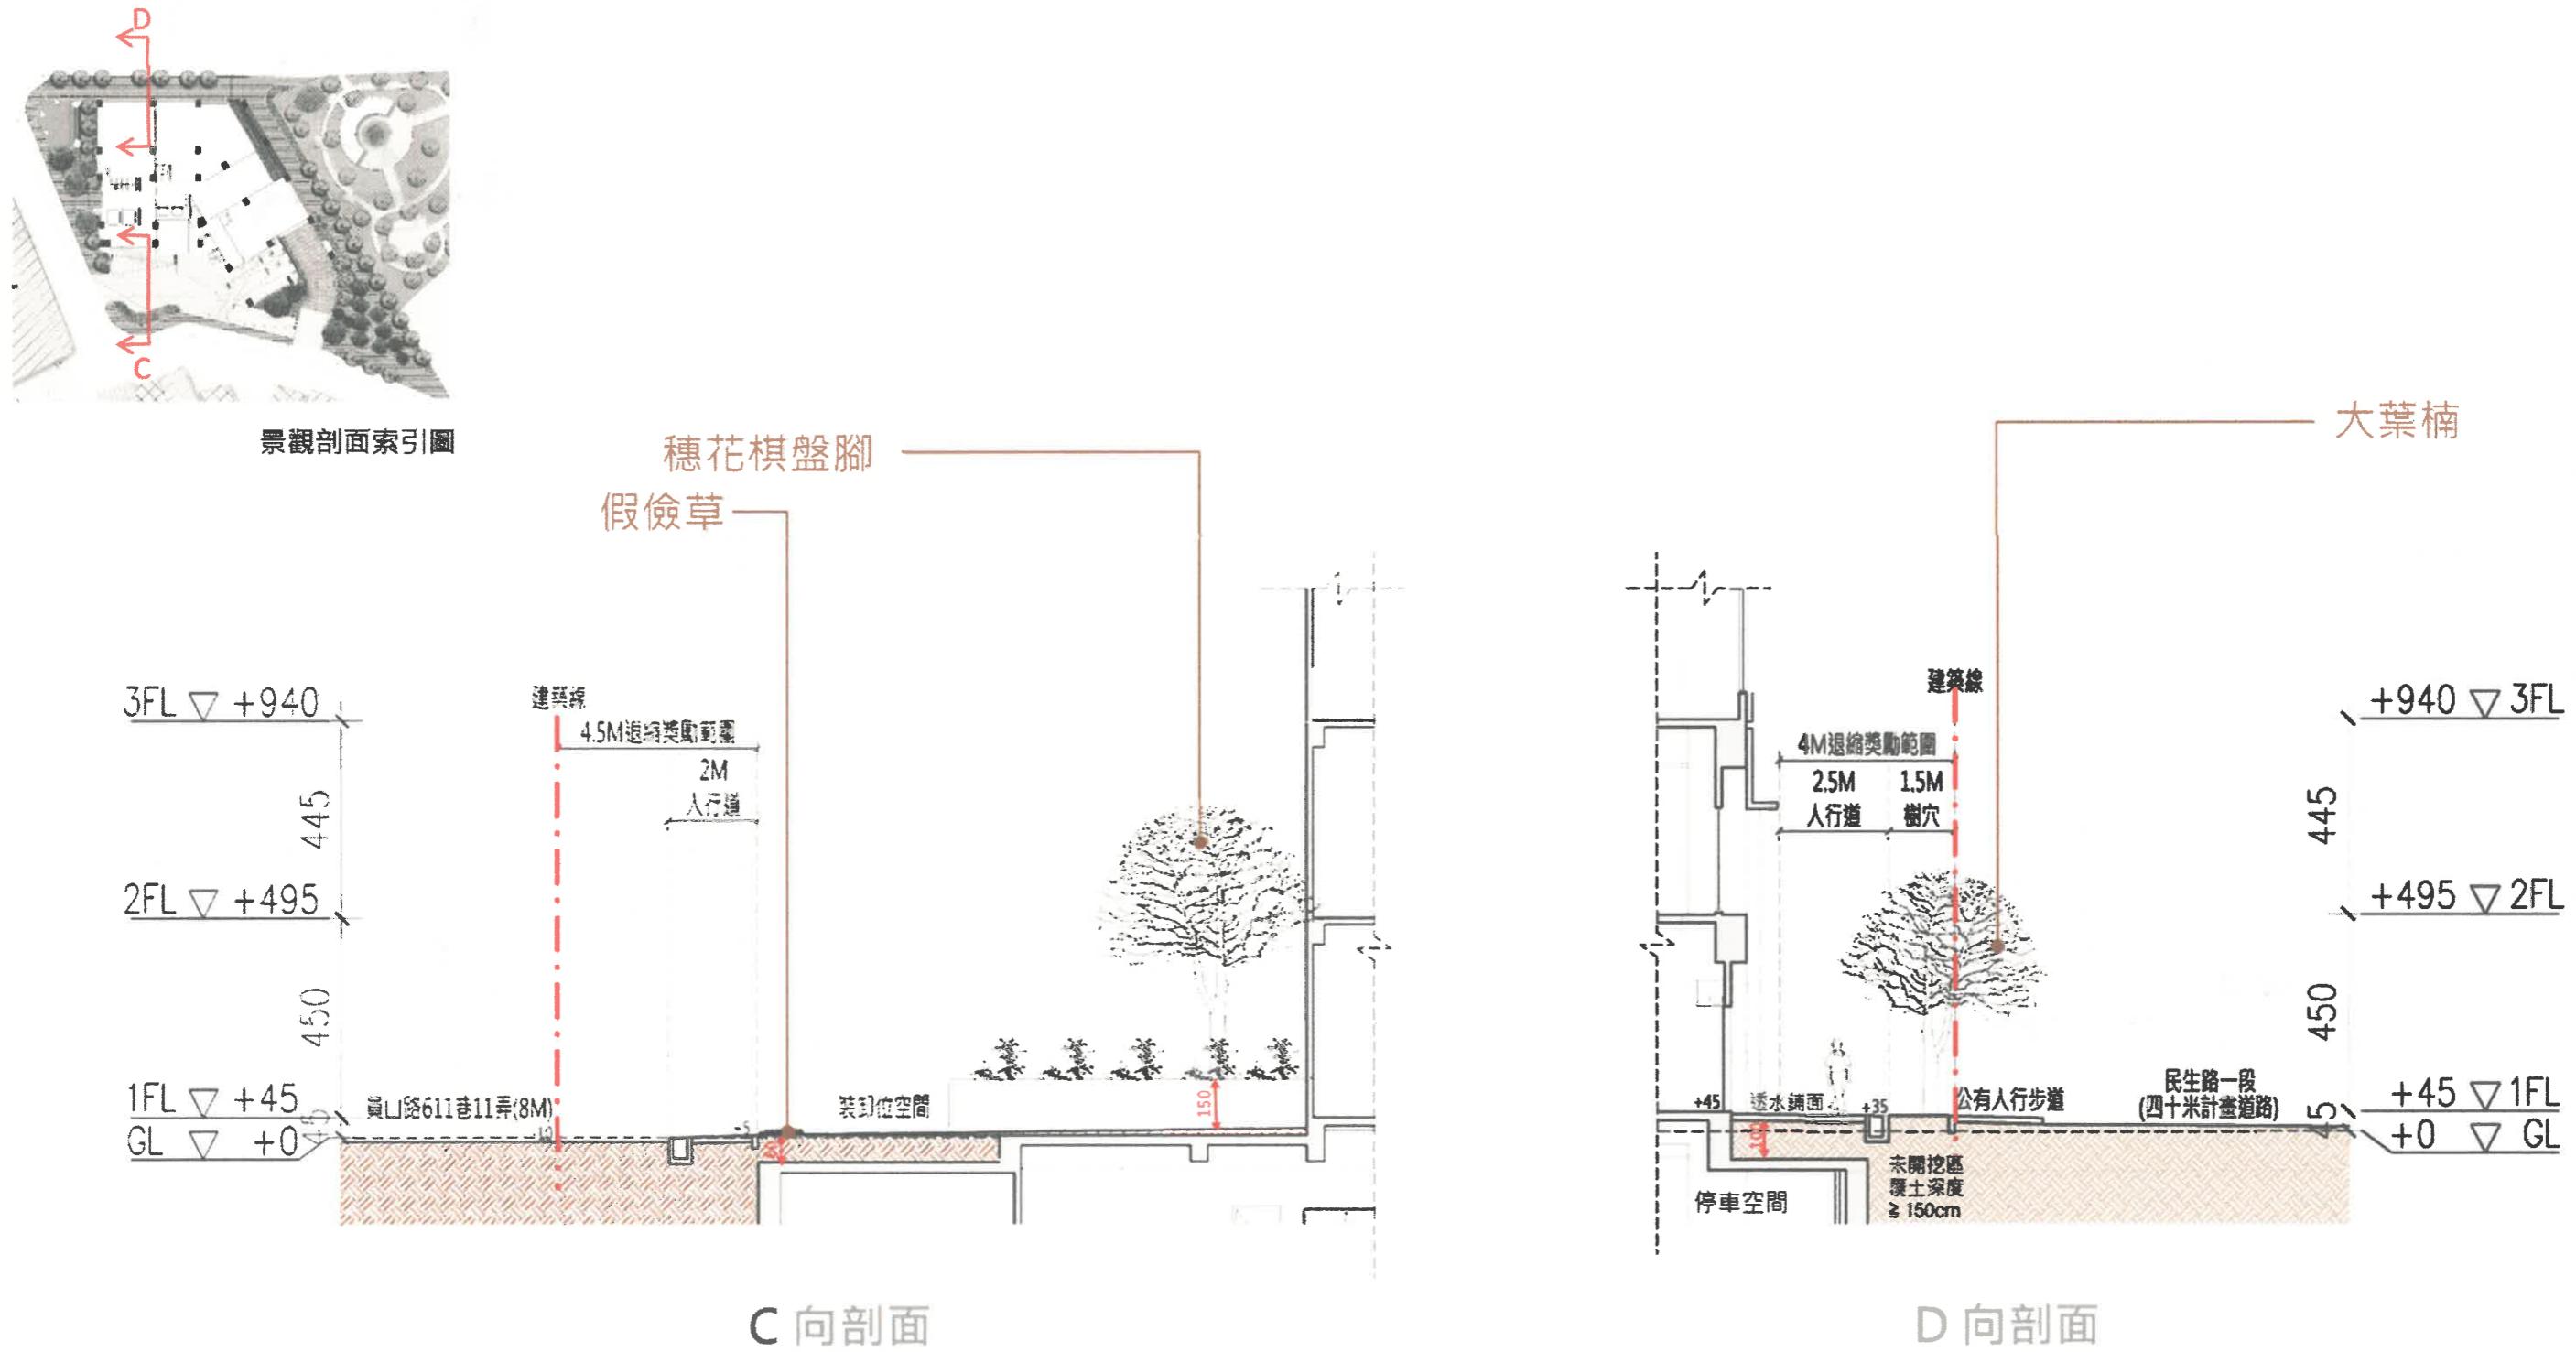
地面層景觀剖面示意圖 2(維持原核定)
